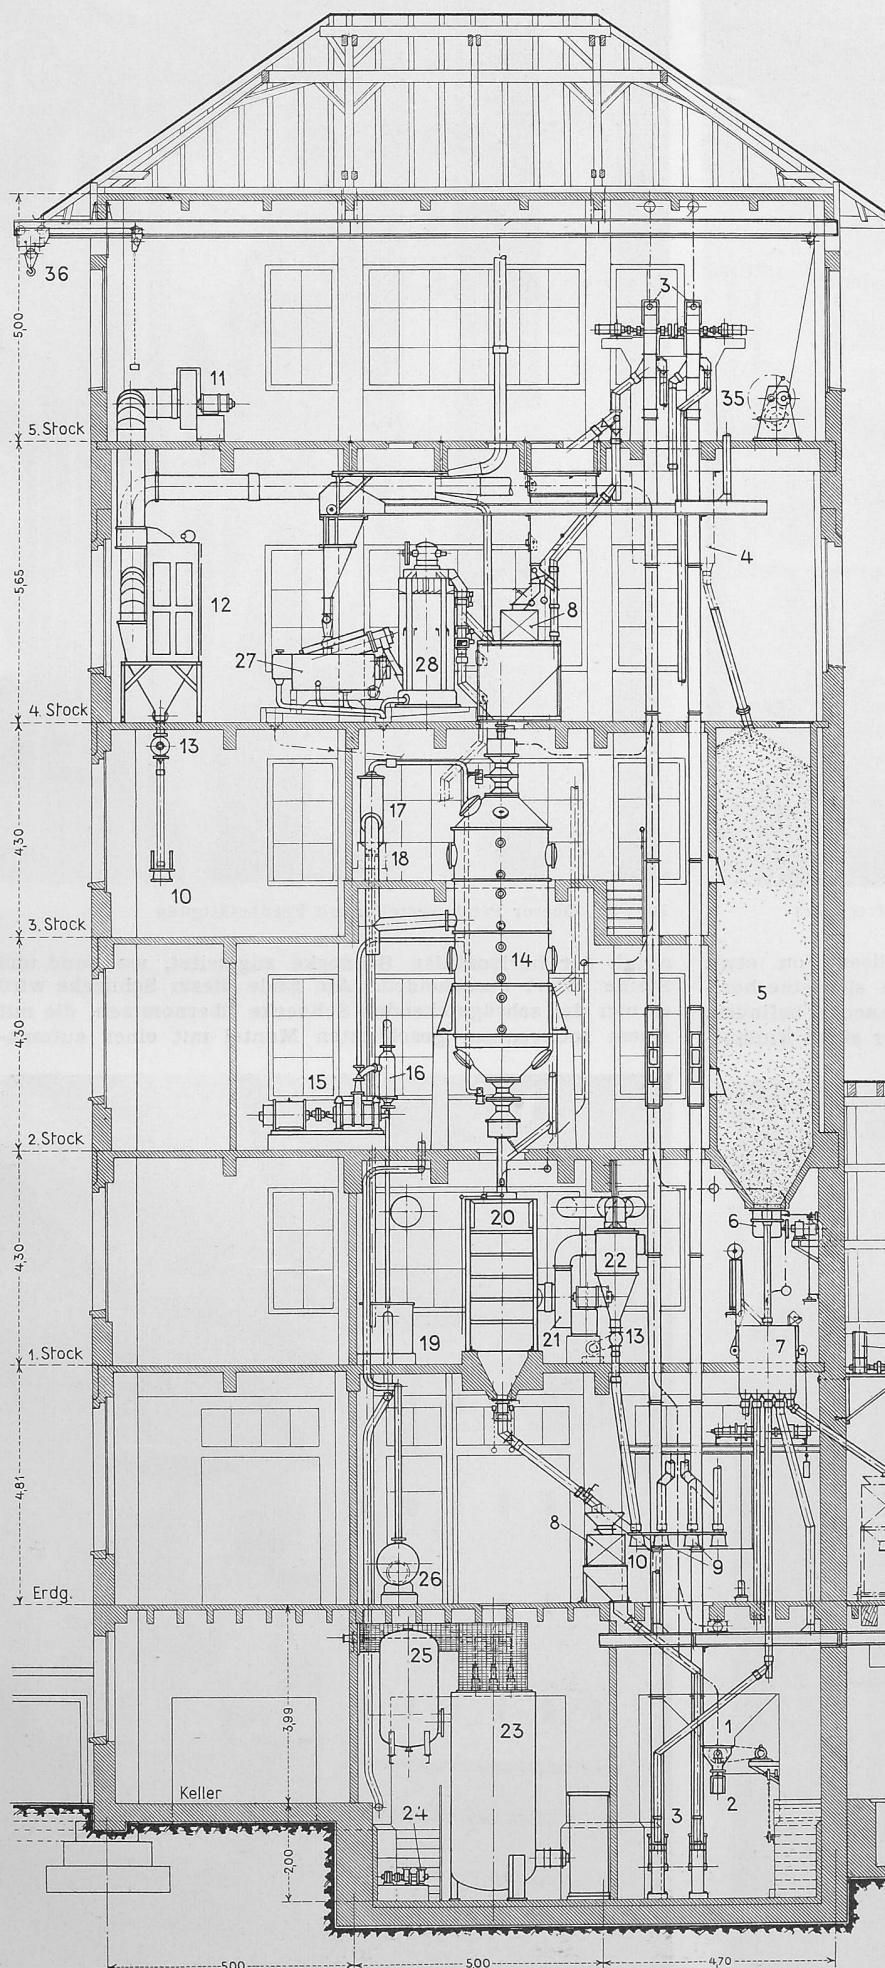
Getreidebehandlungsanlagen im Hochbau, Längsschnitt 1:150
